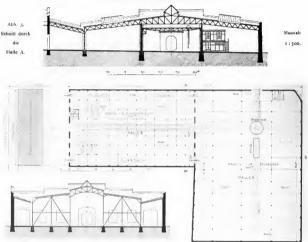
Grundriss der ganzen Hallenanlage (Masstab 1:1000) und Schnitt durch die Halle B (Masstab 1:500).
